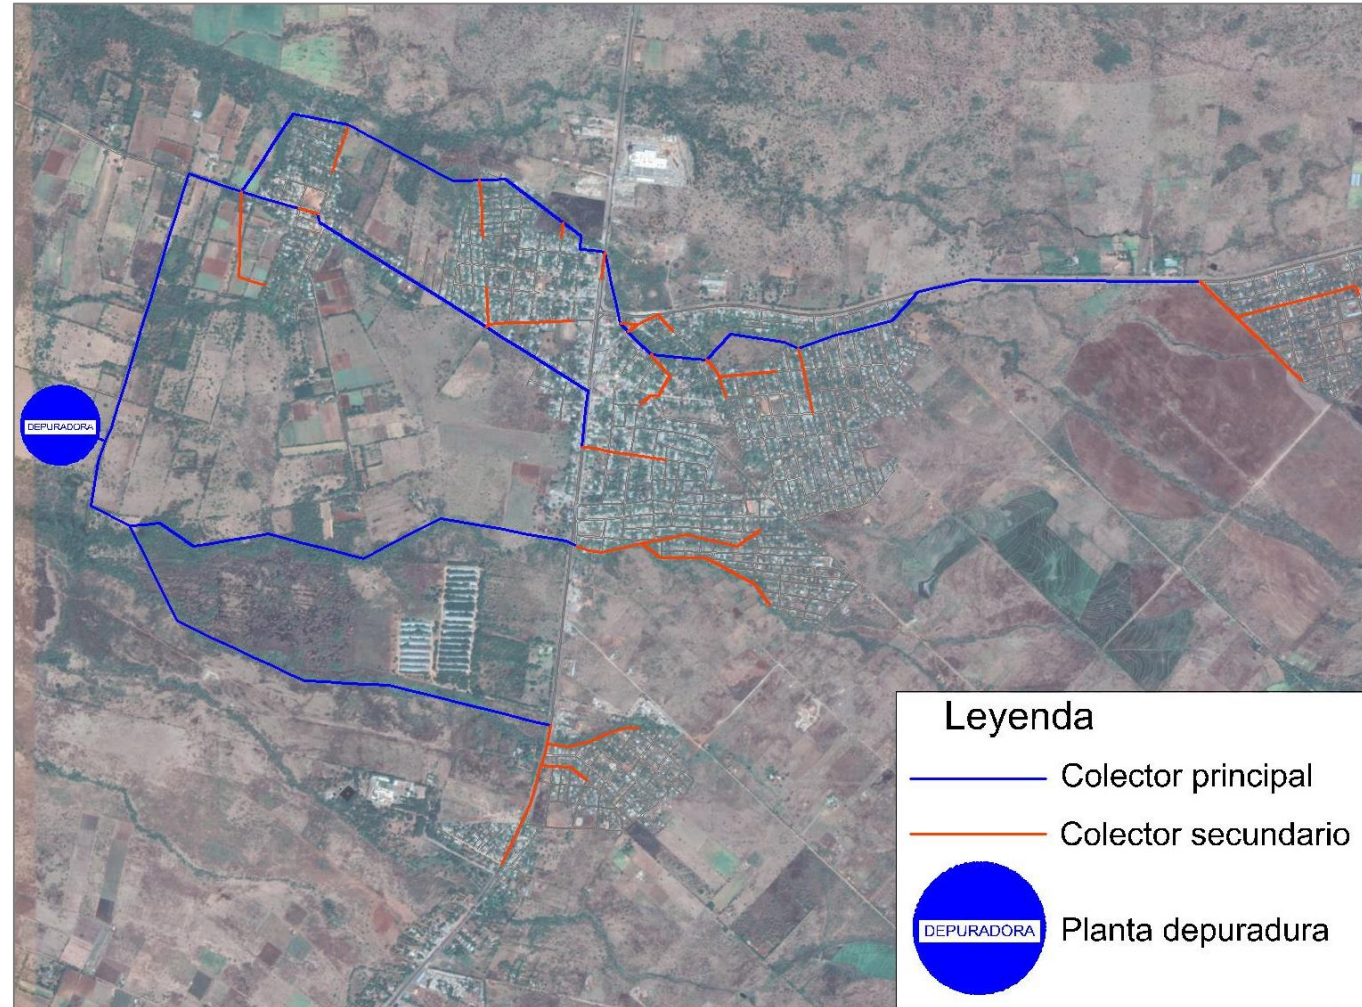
Trazado en planta de la segunda alternativa para la red de saneamiento. Fuente: Elaboración propia.
